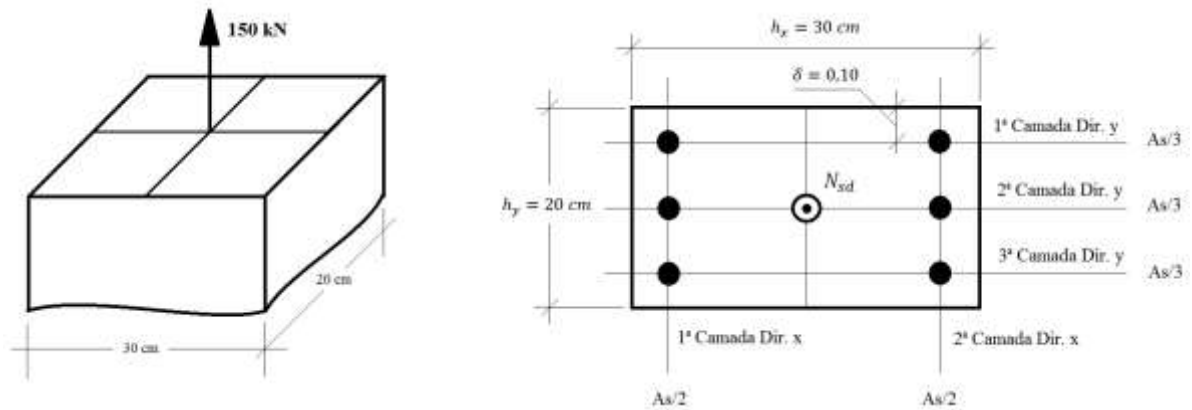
Tirante de concreto armado sob carga: (a) centrada, (b) excêntrica
